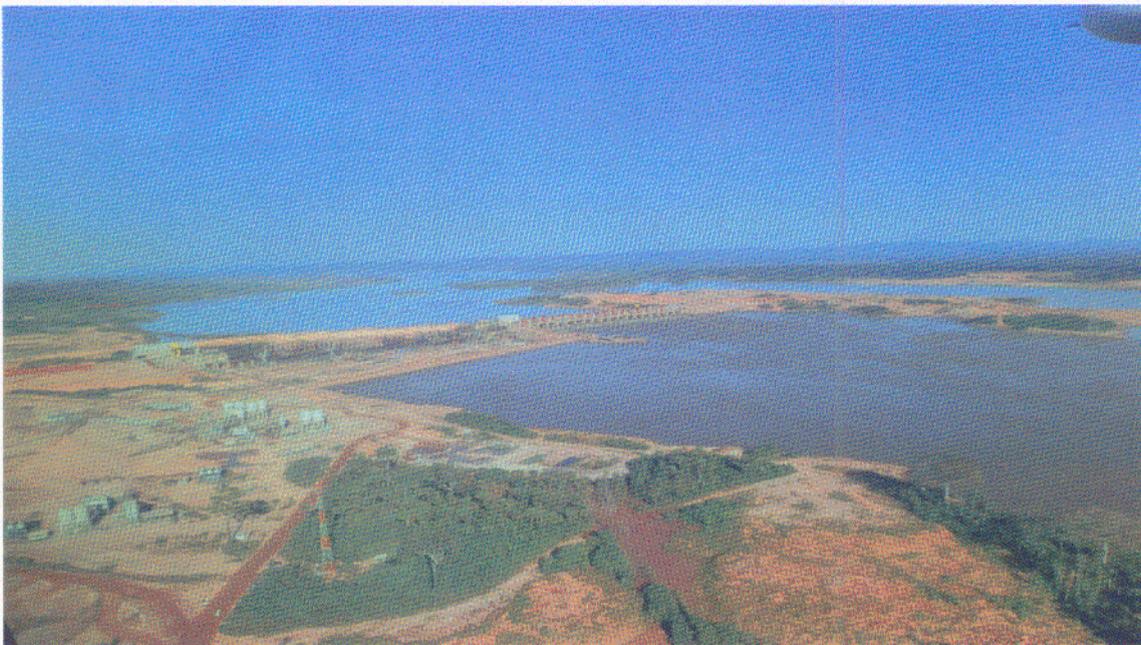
Vista aérea da UHE-Jirau e parte das instalações do canteiro de obras.
